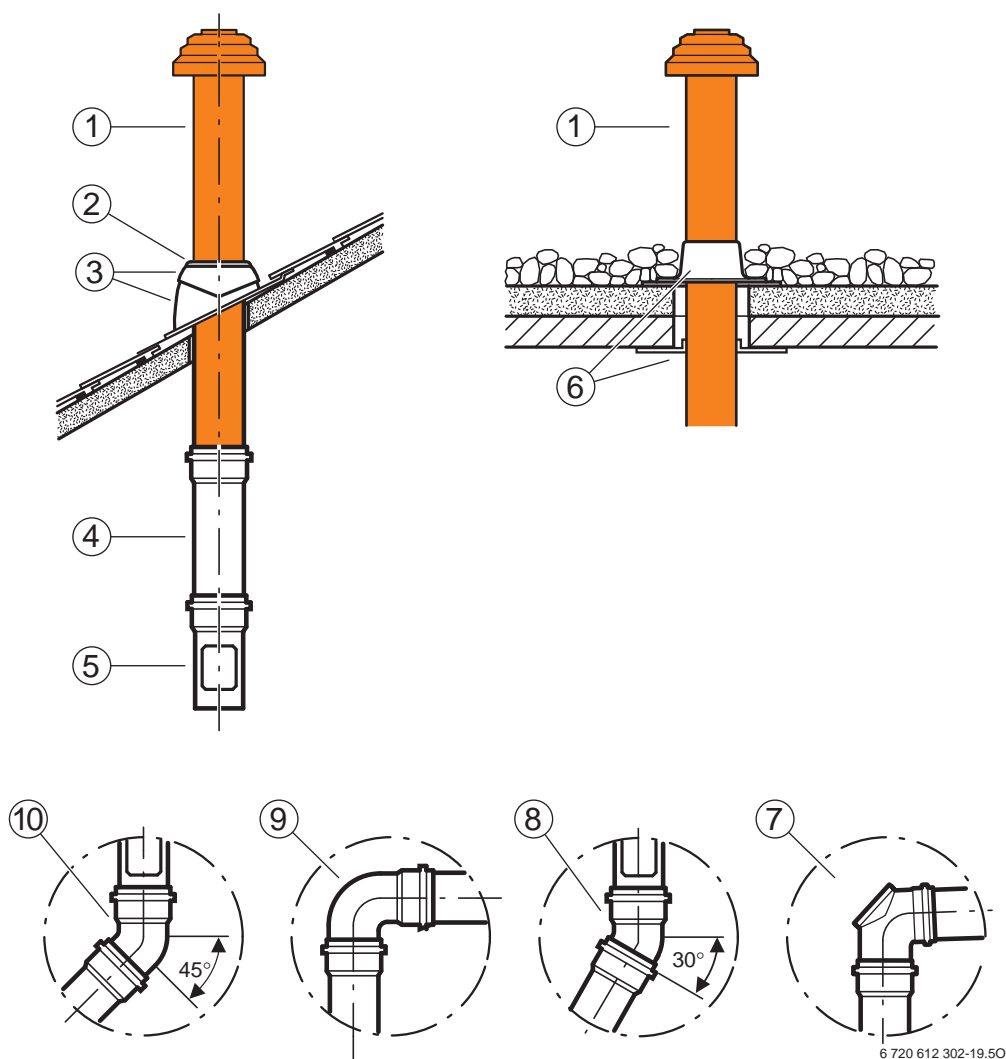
Abgasführung senkrecht Ø 80/125 mm über Dach (C_{33x})
